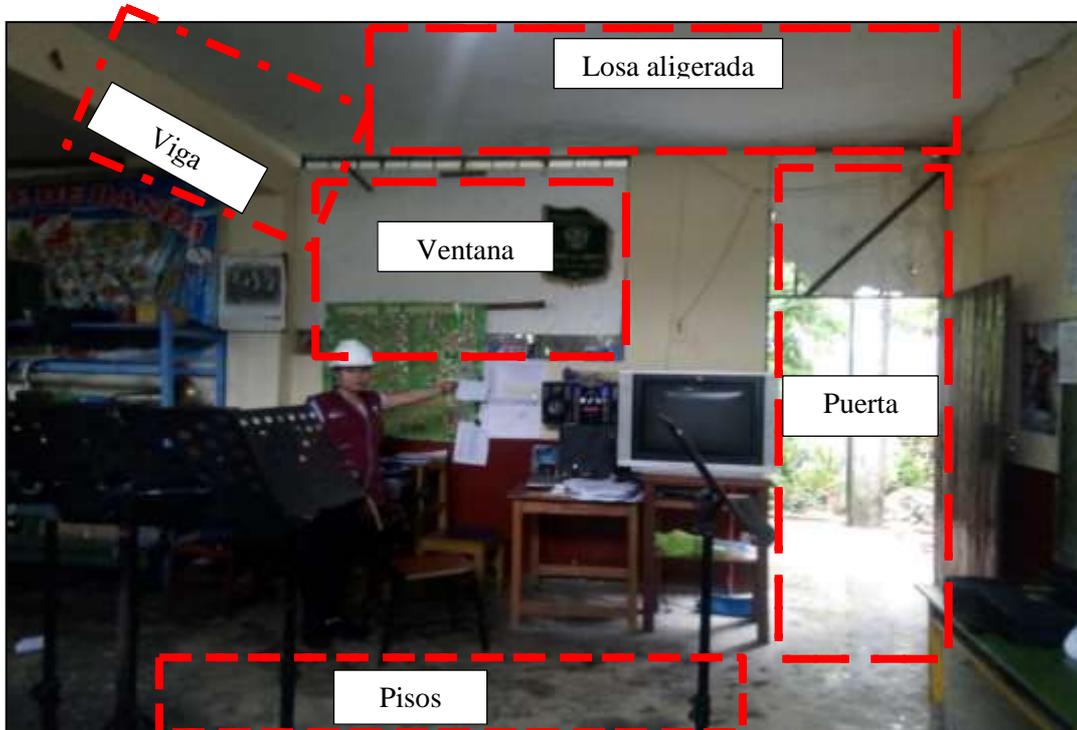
Fotografía de exclusión de puerta, ventanas, vigas, losa aligerada y pisos.
